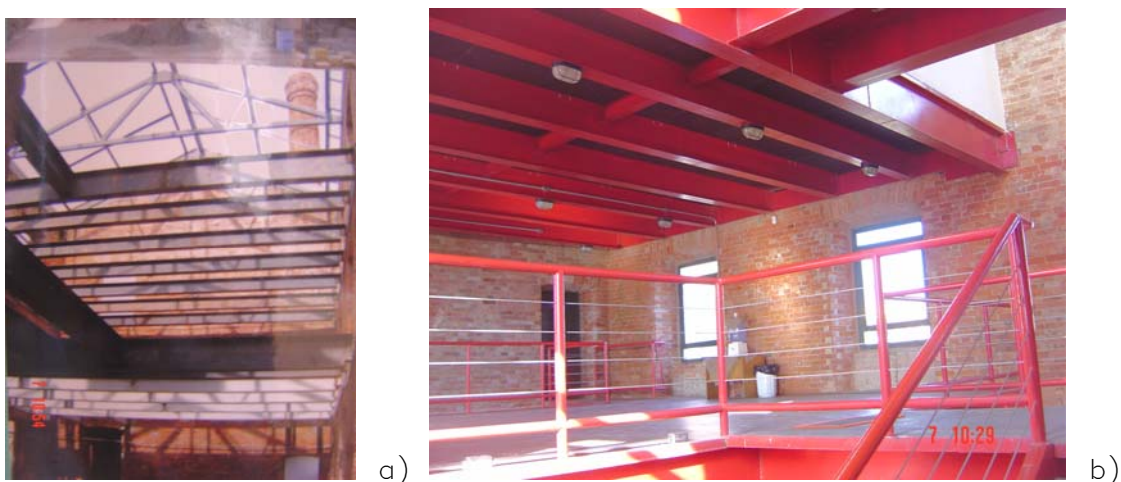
Instalação da estrutura metálica – mezanino primeiro pavimento.
